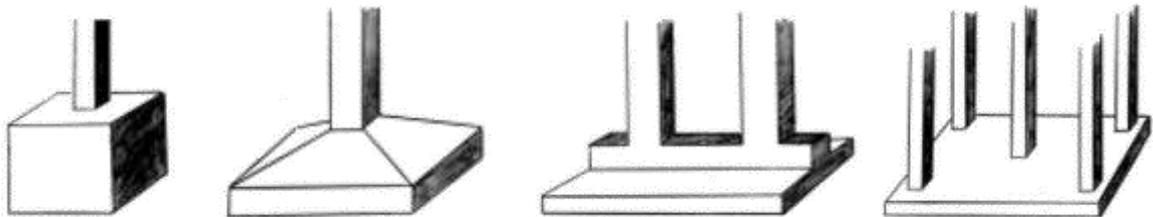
Fundações do tipo directa superficial (Bloco, sapata, viga e radier).
